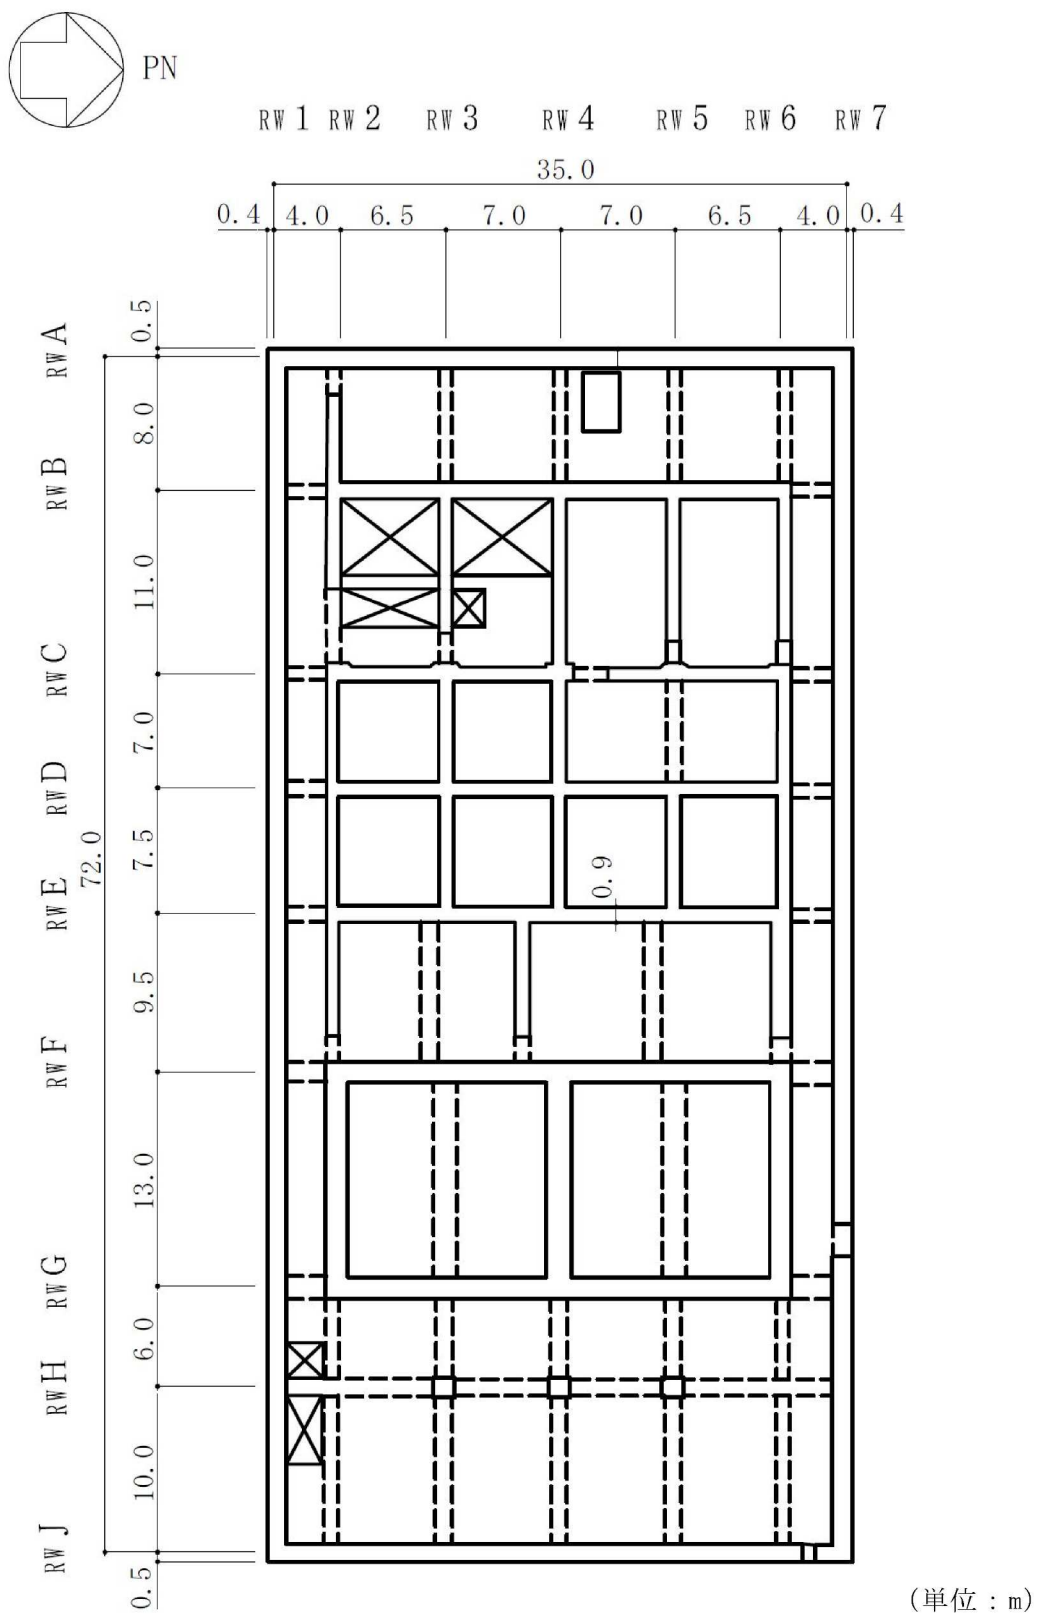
廃棄物処理建屋の概略平面図 (B2F, T.M.S.L. -1.1m) (2/8)
